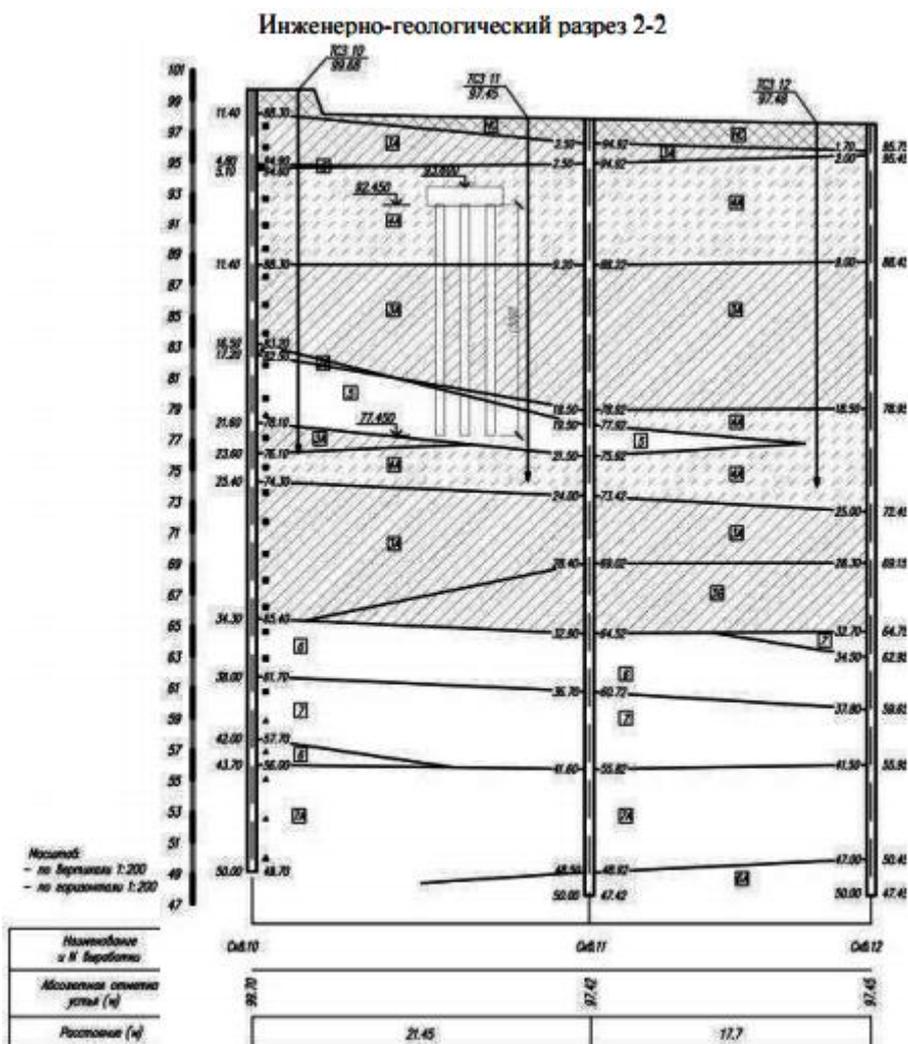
Инженерно-геологический разрез 2-2, совмещенный со схемой проектного расположения конструкций свайно-плитного фундамента (КСПФ) здания
